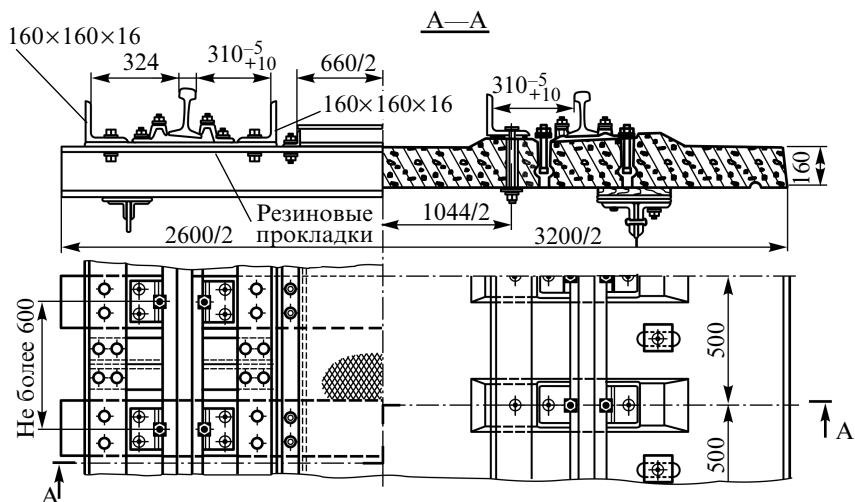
Мостовое полотно на металлических поперечинах (слева) и безбалластных железобетонных плитах (справа)
